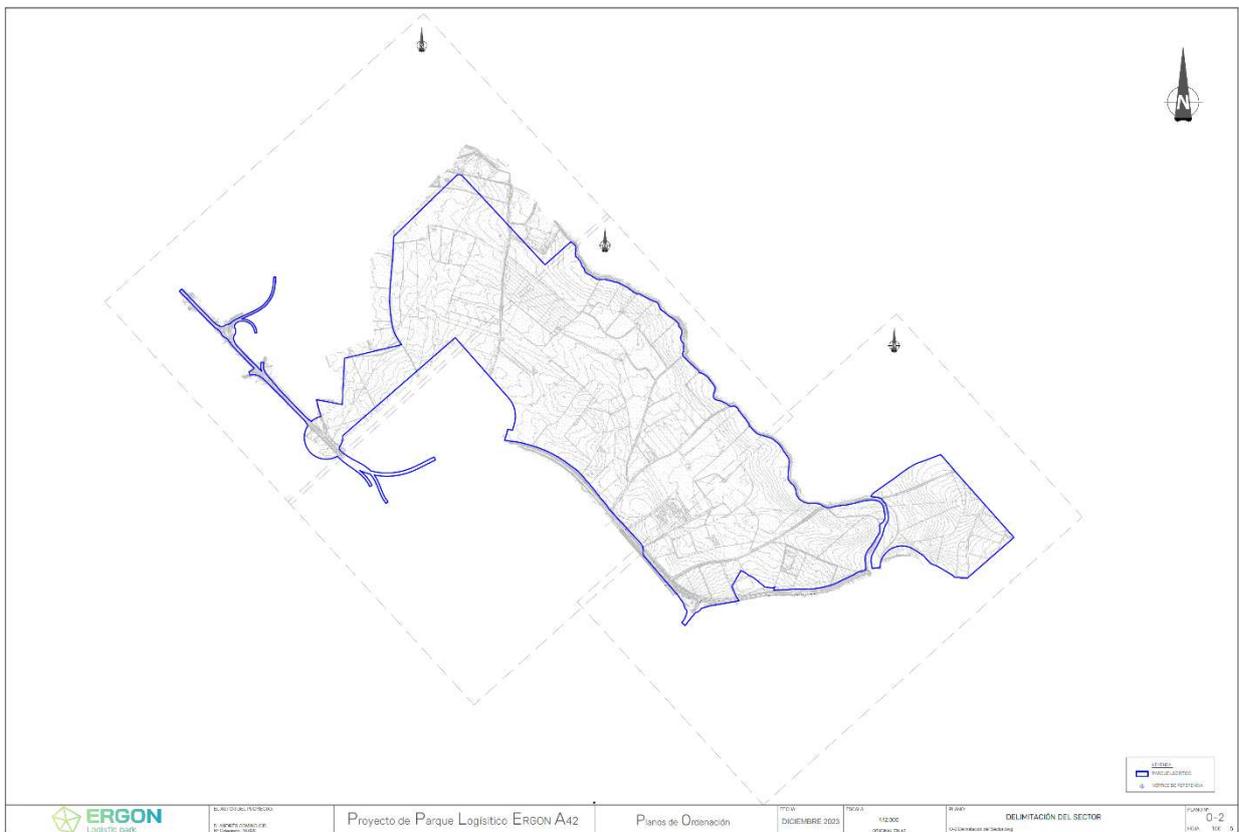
Plano de Delimitación del sector. Fuente: Planos de Ordenación. Ver Anexo I
